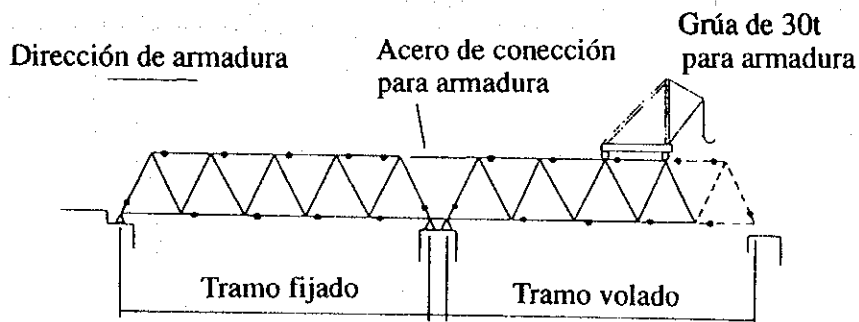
Plano de Concepto de Armadura Volada
